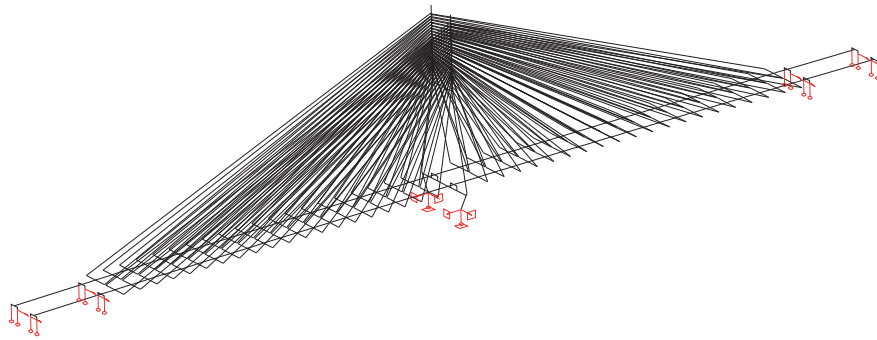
Kształtowanie konstrukcji przęsła w strefach przęseł podwieszonych (zastrzałowe prefabrykaty boczne rozciągane)
